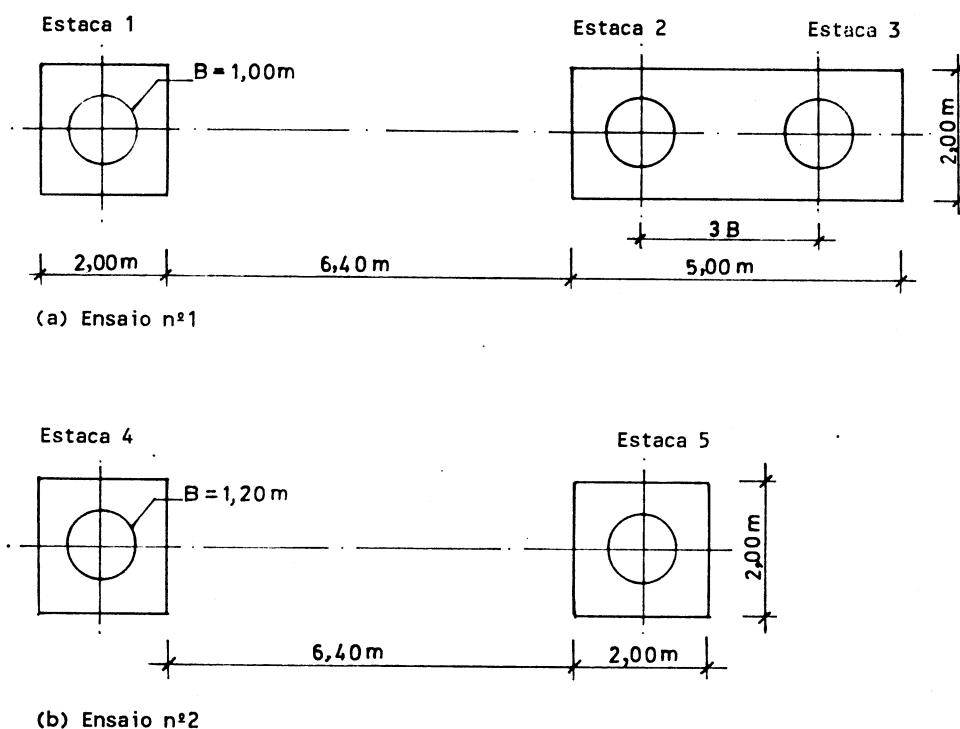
Ponte sobre o rio Sado - planta esquemática da disposição das estacas ensaiadas (Adaptado de Sousa Coutinho *et al.*, 1991a; 1991b)
